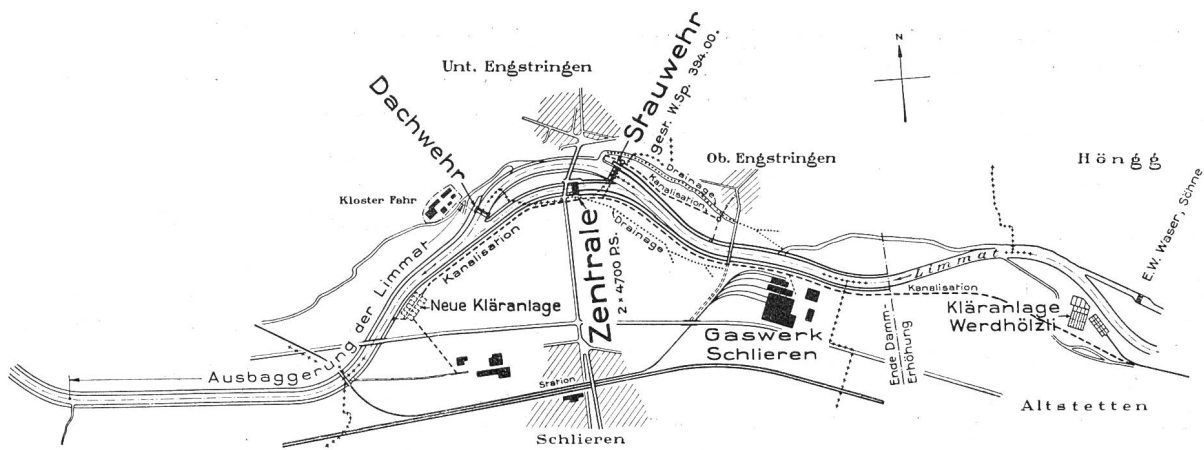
Projektiertes Kraftwerk Schlieren. Situationsplan Maßstab 1:40000.
